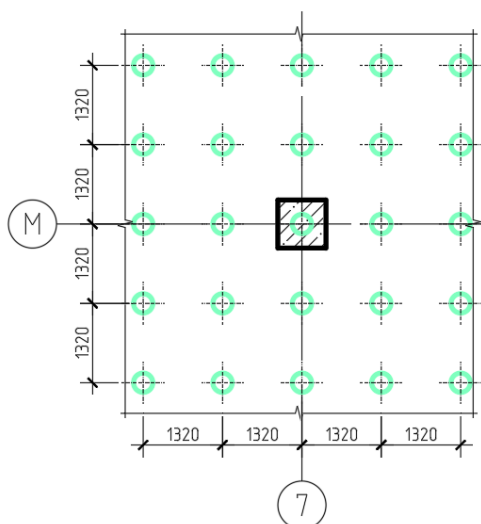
Схема расположения свай под фрагмент плитного фундамента
